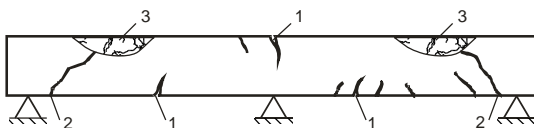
Характерные трещины в изгибаемых железобетонных элементах, работающих по балочной схеме:
